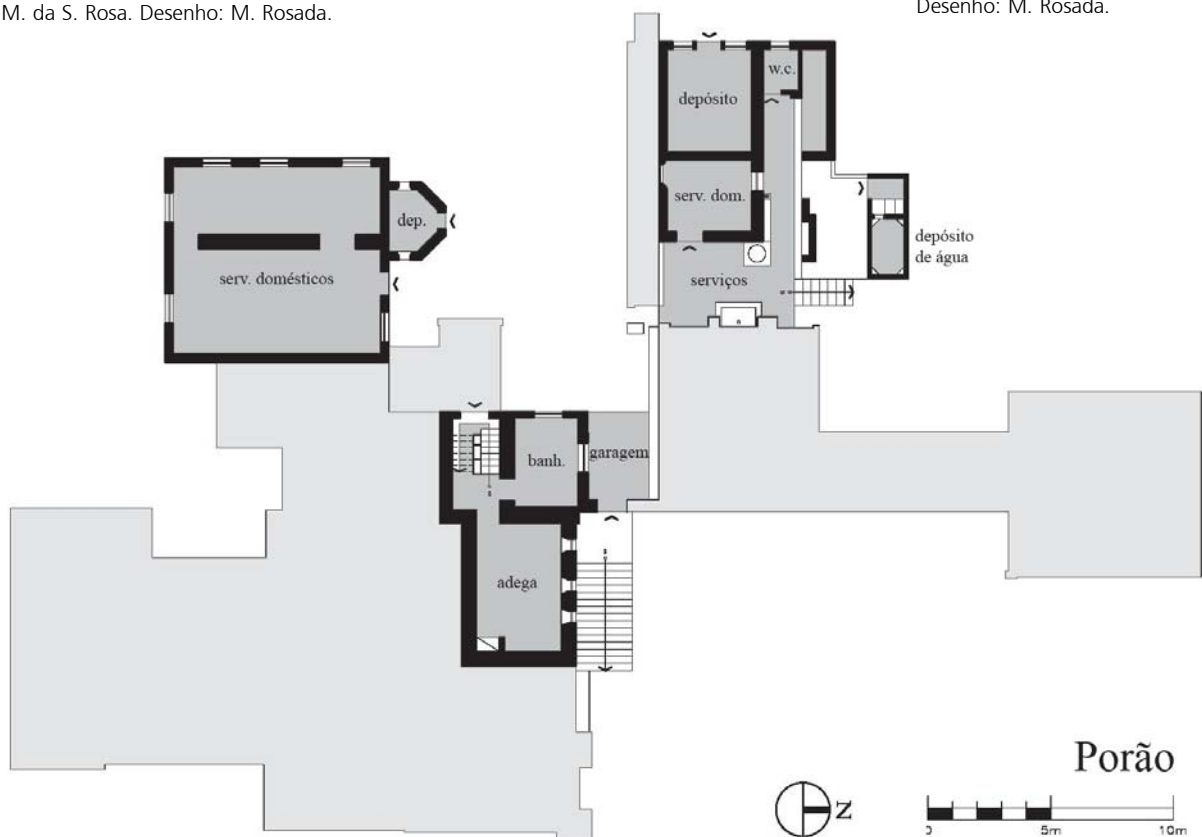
(abaixo) - Planta do porão. Casarão da fazenda Nossa Senhora Auxiliadora, Restinga. Lev.: V. Benincasa e L. M. M. da S. Rosa. Desenho: M. Rosada.
